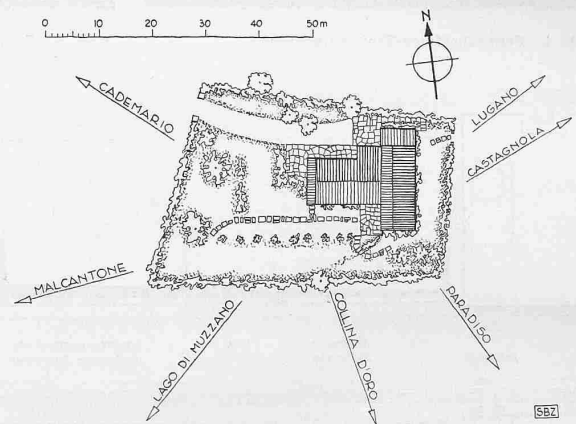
Lageplan des Wohnhauses «Moncucchetto». — 1:1250
